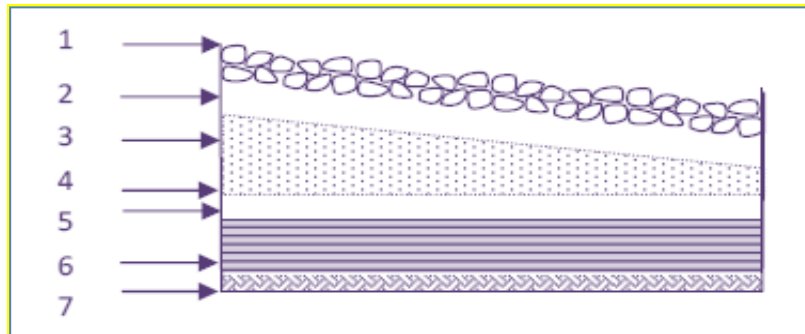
Coupe verticale du dernier plancher (terrasse inaccessible).
